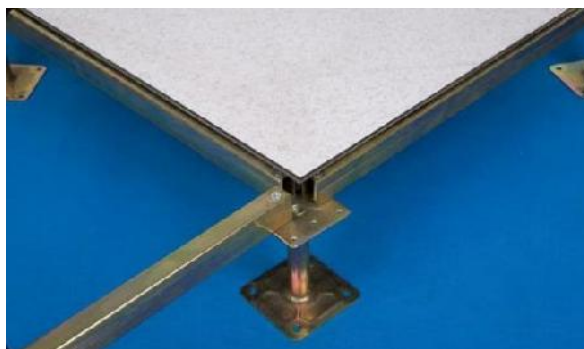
Travesaño y pedestal metálico para baldosa de piso falso.
